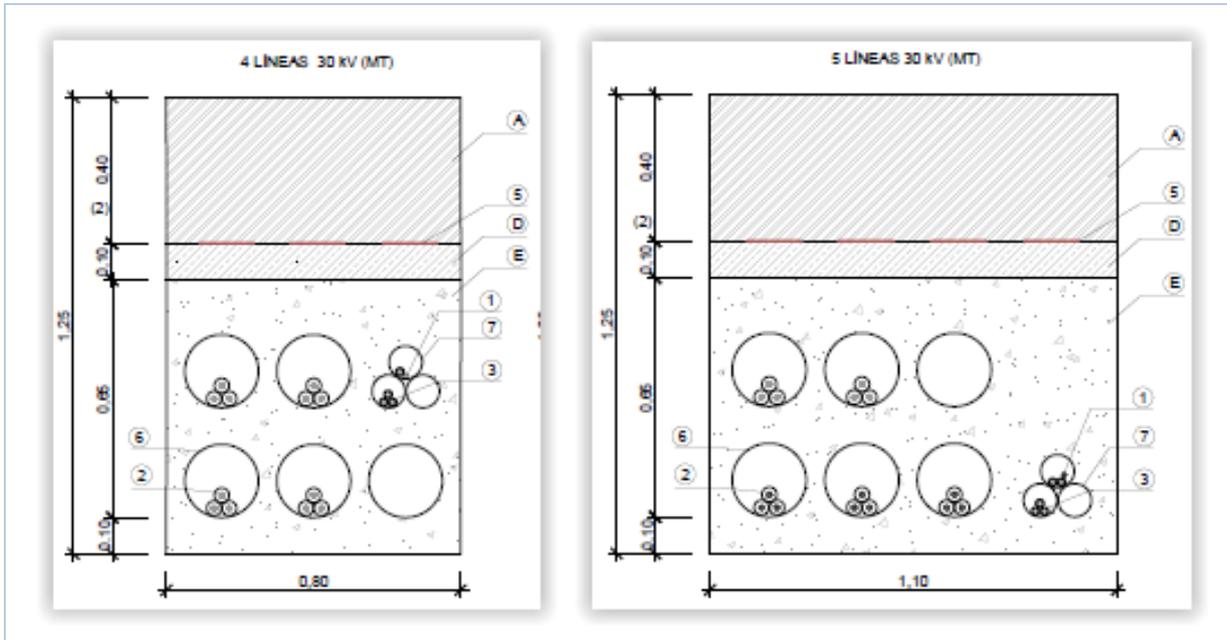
Detalle Sección Zanja. Tipo cruce vial o barrancos (2 de 2)
